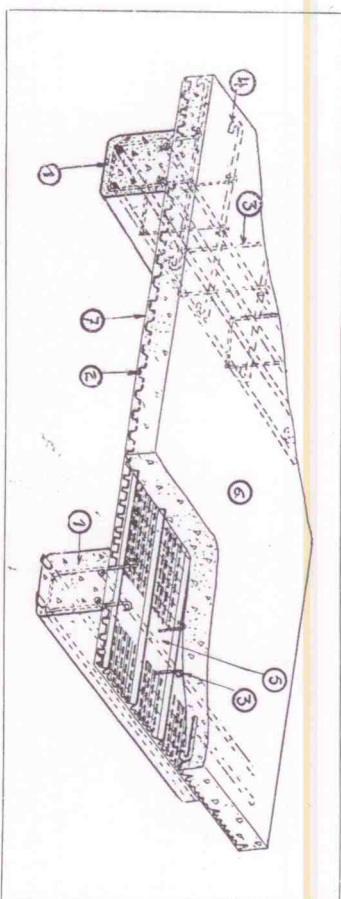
1 — Viga de concreto armado fabricada com antecedência; 2 — Metal Farco; 3 — Estribos; 4 — Armadura no engaste; 5 — Malha recortada do Farco para ligação infima da viga com a laje; 6 — Concreto; 7 — Revestimento.
